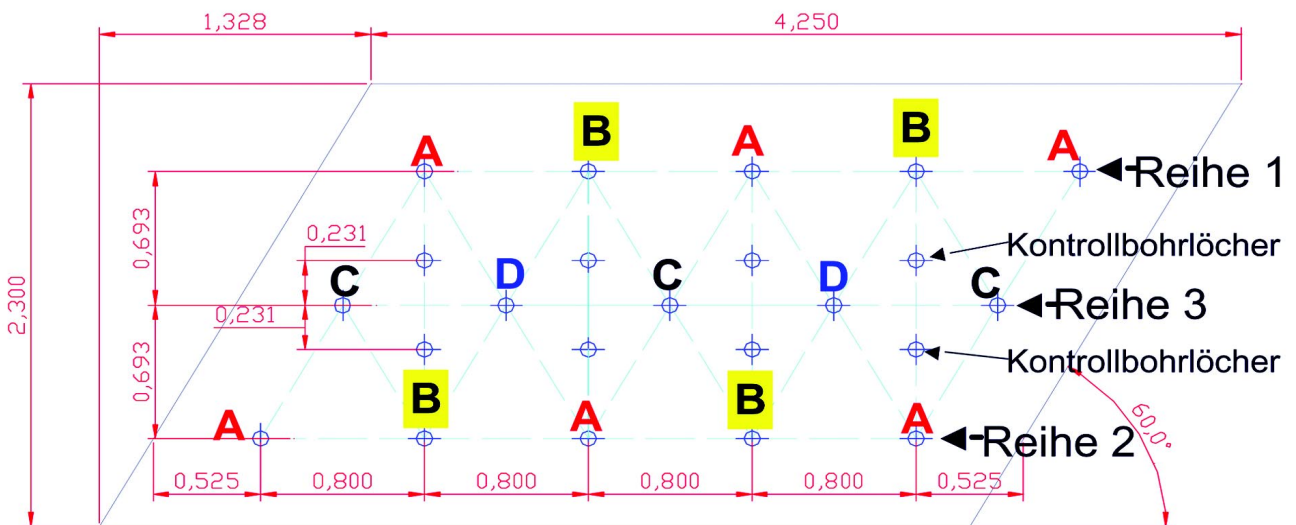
Großversuch - Grundriss einer Fundamentplatte mit Bohrlochraster und zugehöriger Bezeichnung
